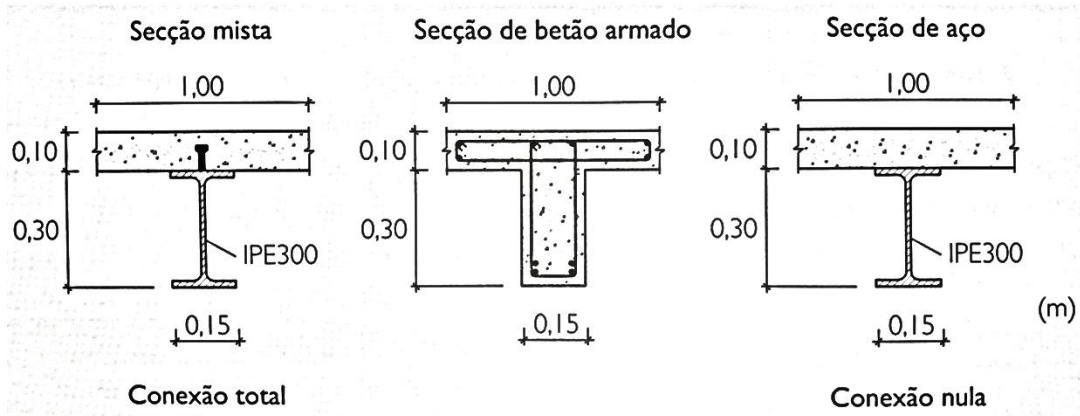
Soluções estruturais para as vigas utilizadas no estudo comparativo [1].
